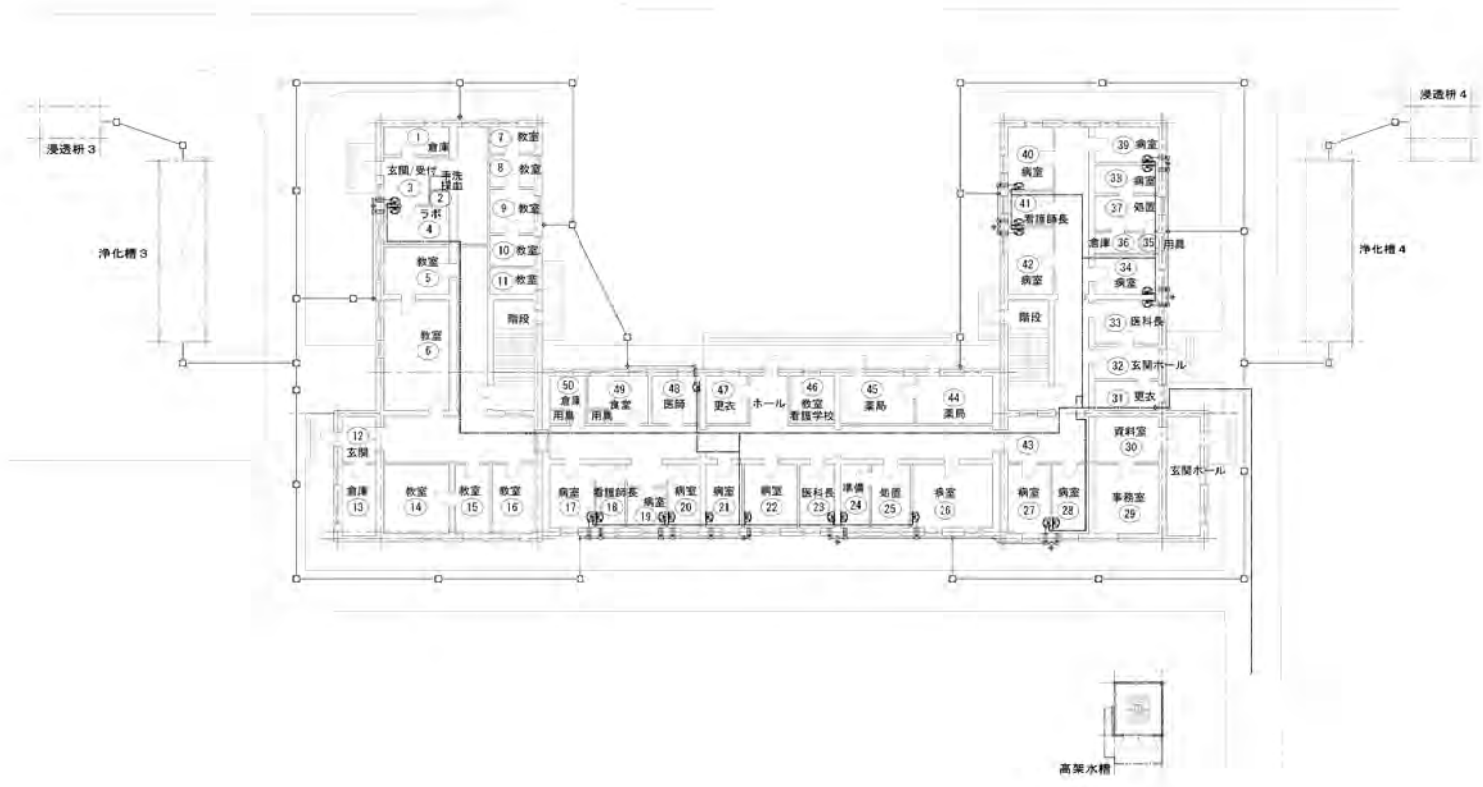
ジョミ郡中央病院 小児科棟 1F平面図 / 給排水計画図 1/300
